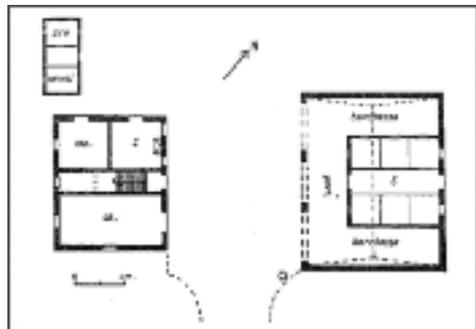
Pianta del cortile rurale modenese - esempio di barchessa riunita al fienile.
